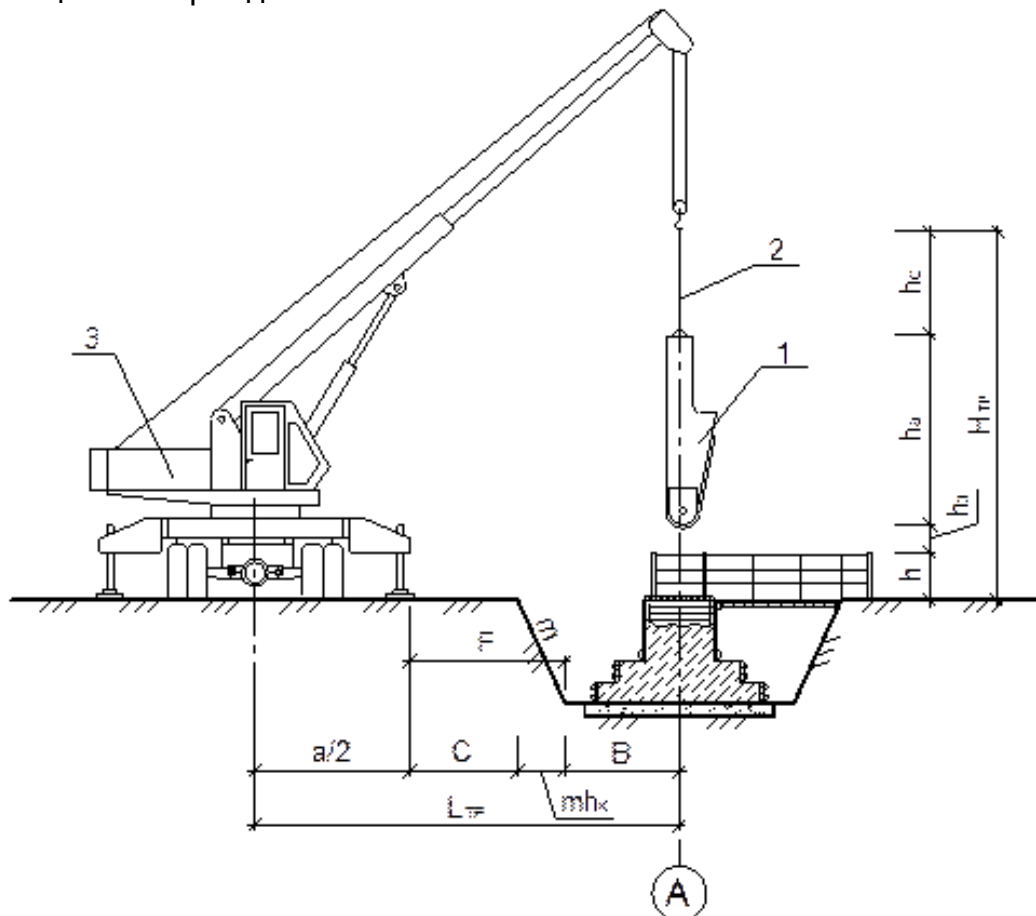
Схема к определению  $H_{тр}$  и  $L_{тр}$  при бетонировании монолитных фундаментов
